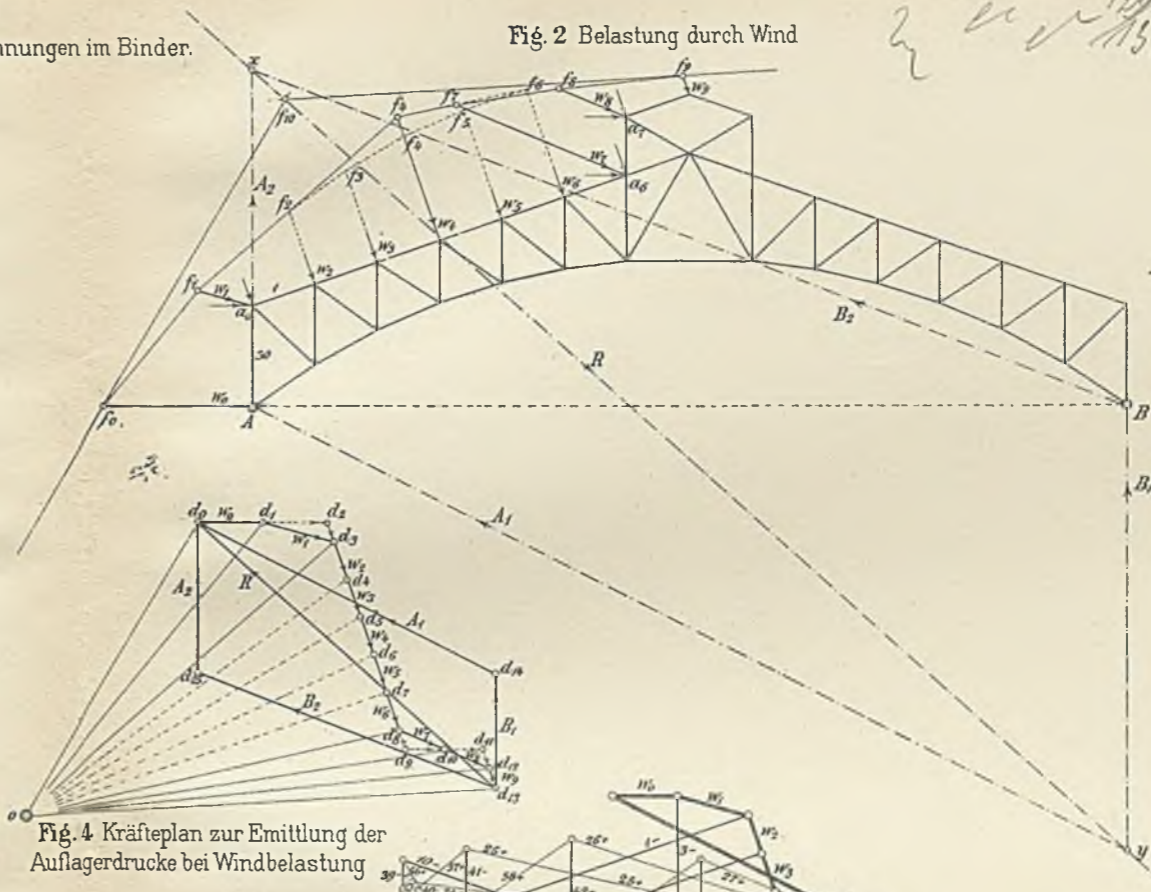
Kräfteplan zur Ermittlung der Auflagerdrucke bei Windbelastung
